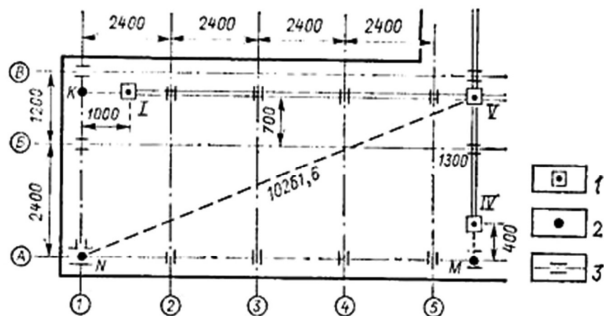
Схема детальной разбивки осей на монтажном горизонте
